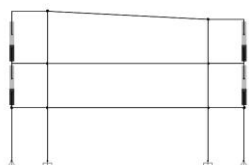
Giunti tipo della struttura, incastro a terra e connessione trave-pilastro.
